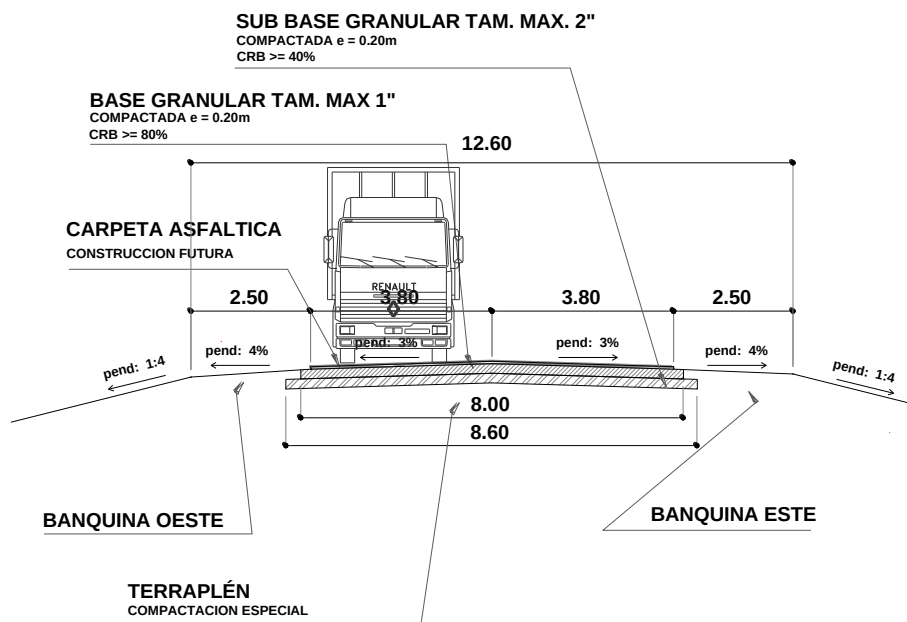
Perfil Transversal "Tipo" del camino de acceso
